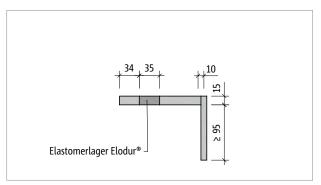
Schöck Tronsole® BL, BZ: Grundriss, beispielhafte Darstellung Tragstufe V1, Länge 1500 mm
